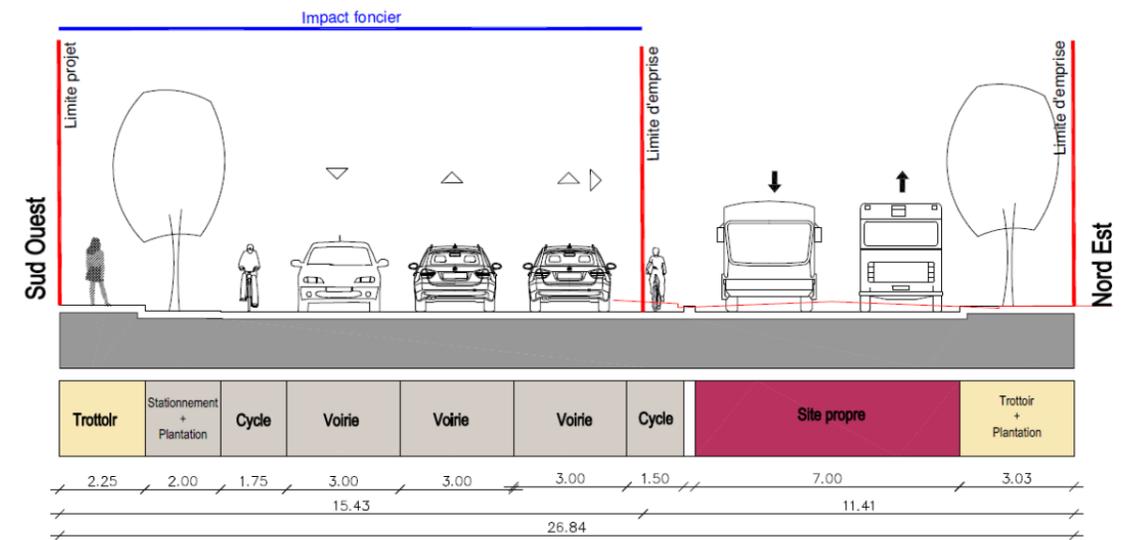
Coupe type en section courante sur le boulevard du Général Delambre
